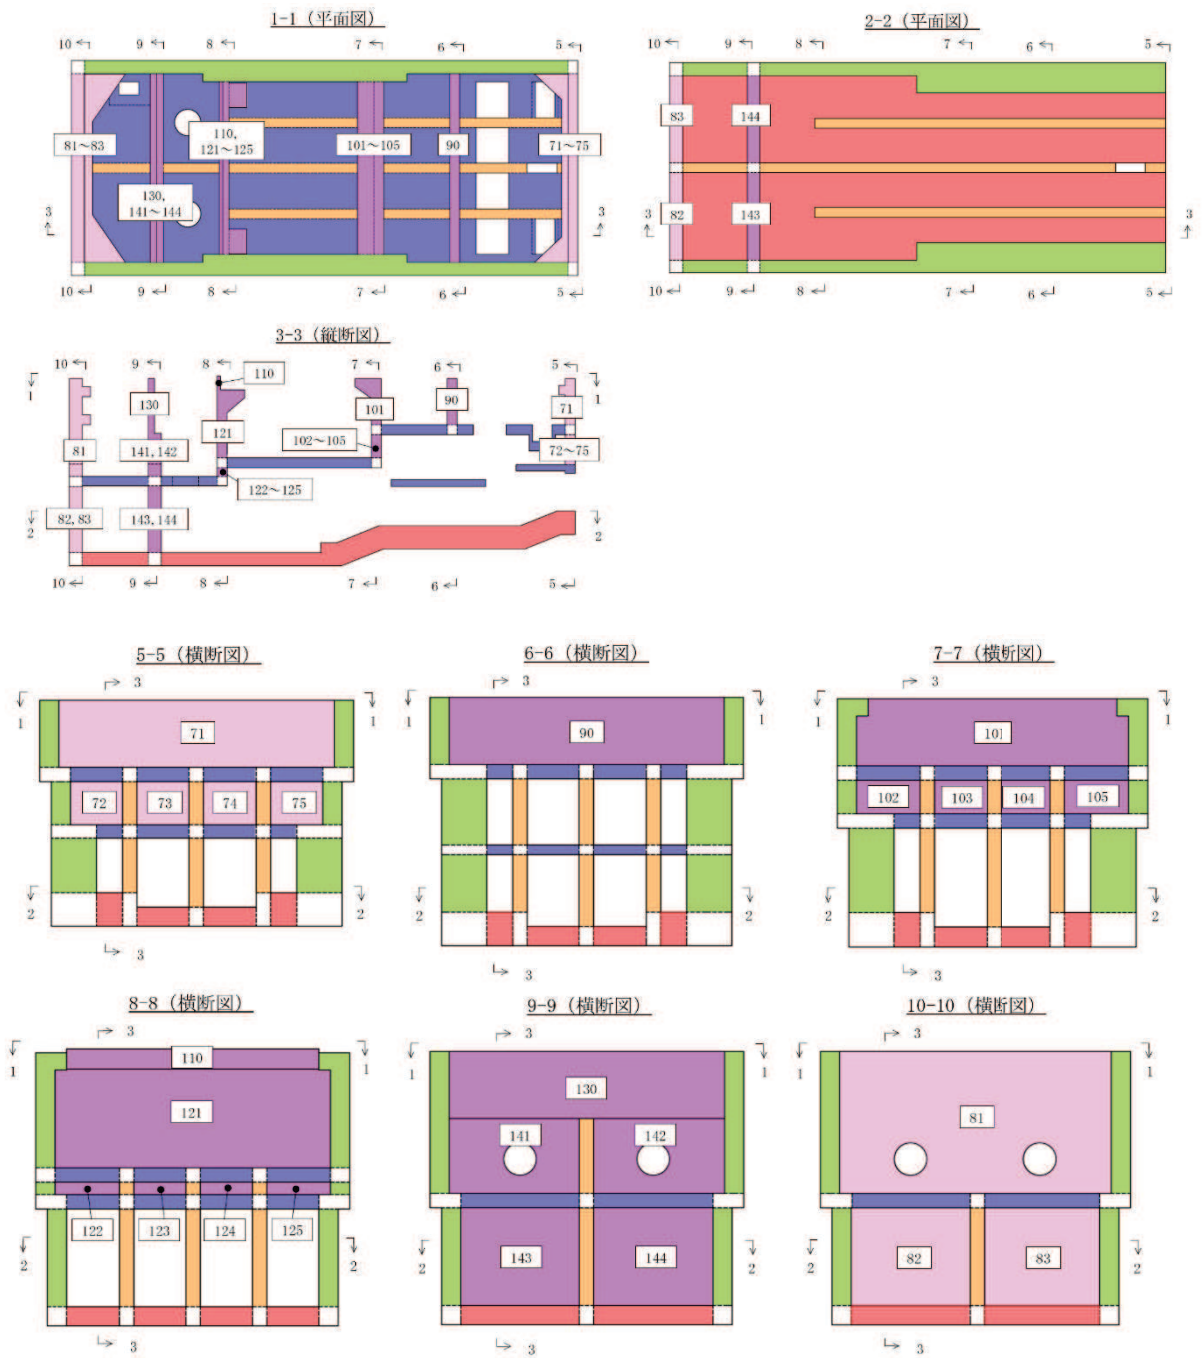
(3) 海水ポンプ室 評価位置図 (曲げ・軸力系の破壊及びせん断破壊)
